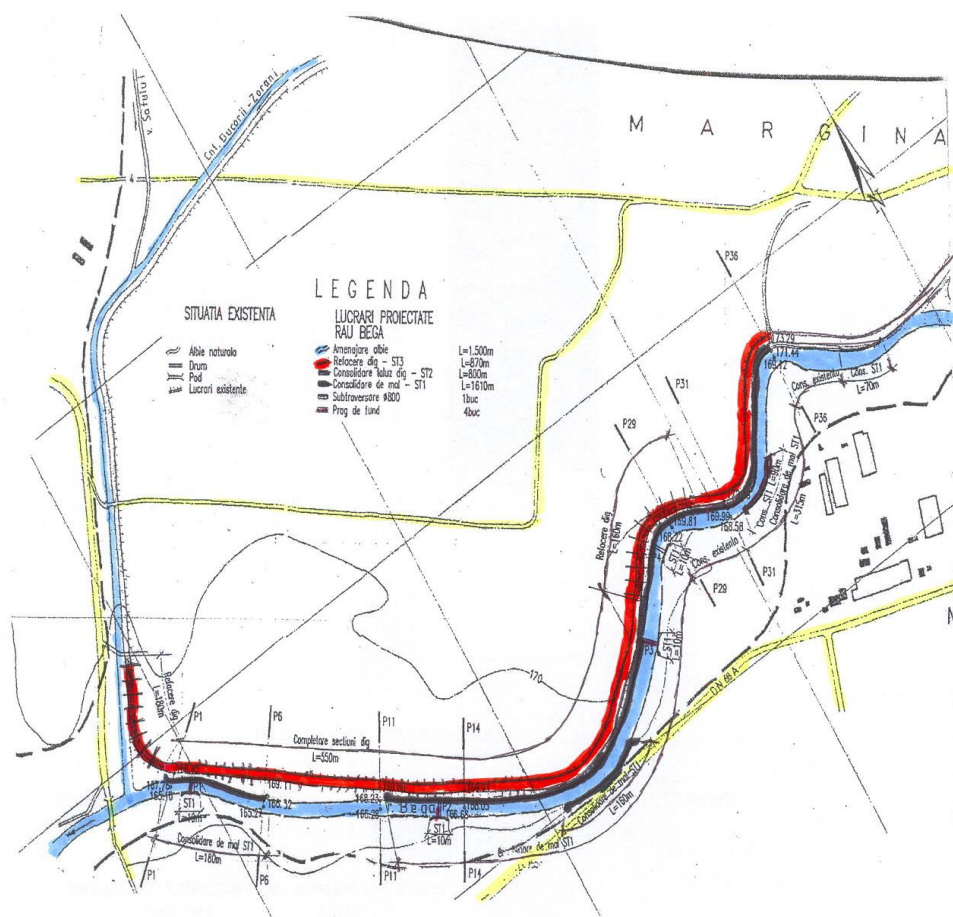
Plan de situație râul Bega în zona localității Margina
